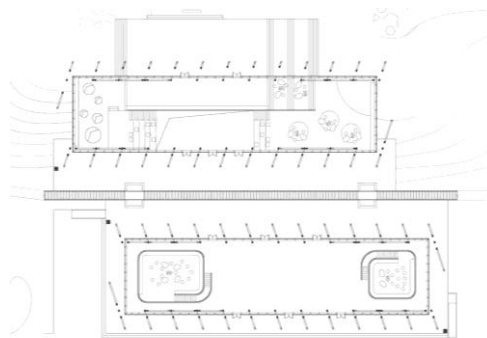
Plantas da Estação Ferroviária Ginkgo. Fonte: Archidaily
